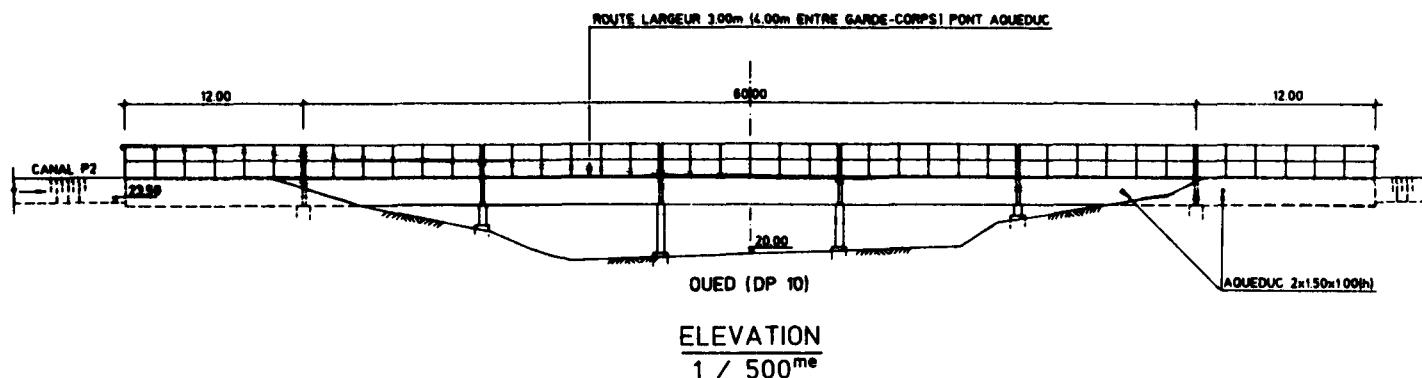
PONT AQUEDUC SUR L'OUED KOW. PLAN TYPE
